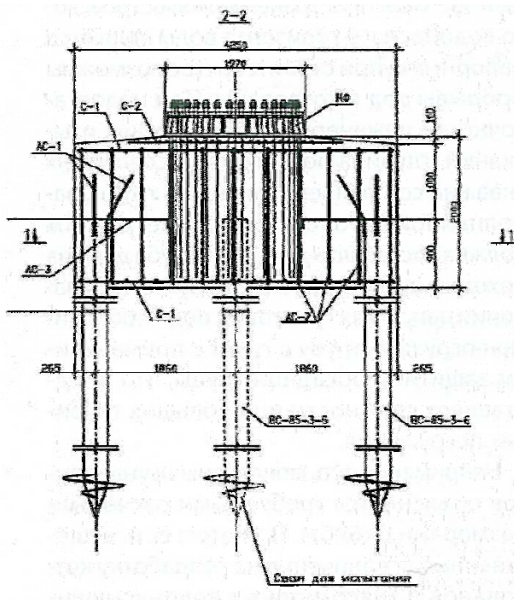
Фундамент из винтовых свай для опоры МПГ330-2т.
